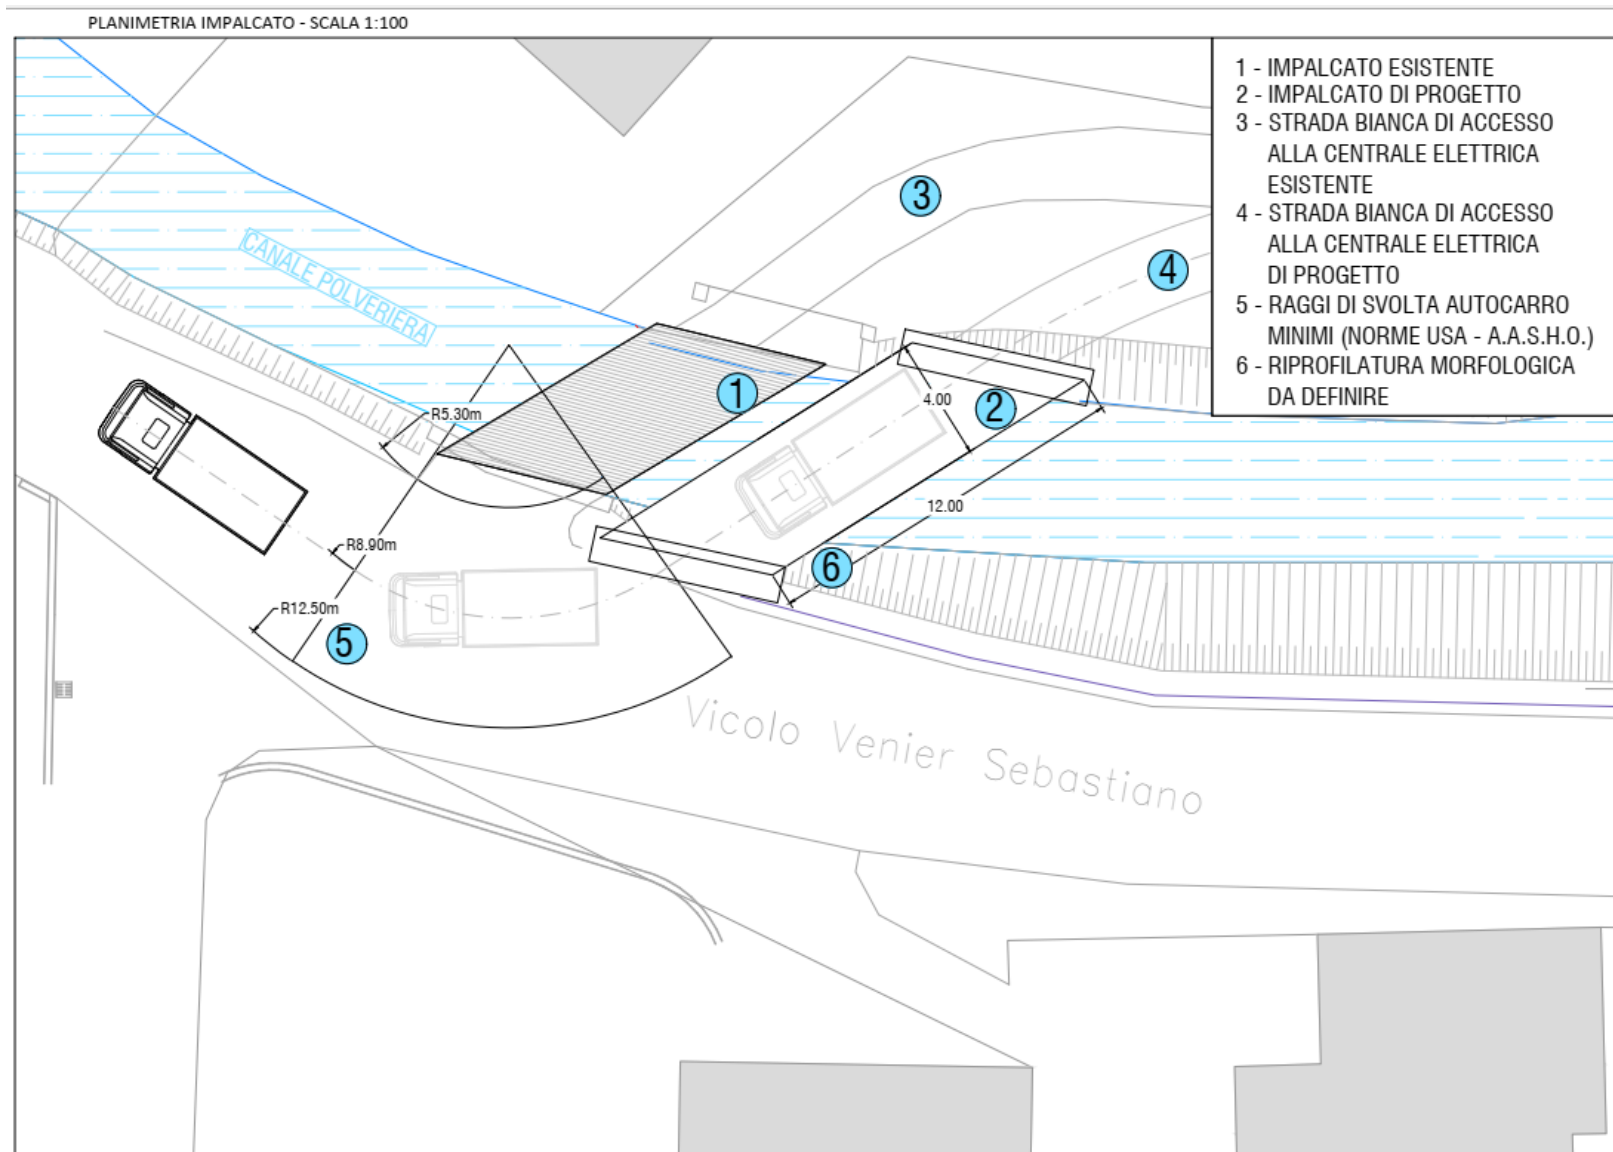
E : Inquadramento planimetrico PROGETTO CANALE DELLE POLVERIERA LUNGO VICOLO VENIER SEBASTIANO
